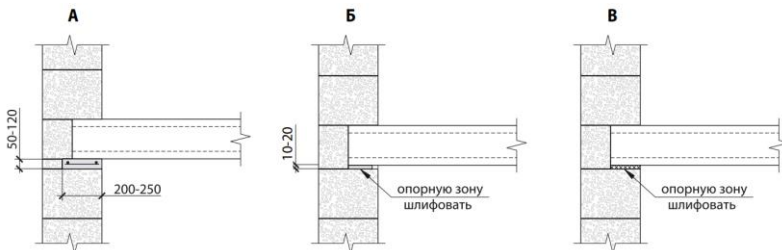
Варіанти монтажу залізобетонних перекриттів на стінах з блоків AEROC [3]
